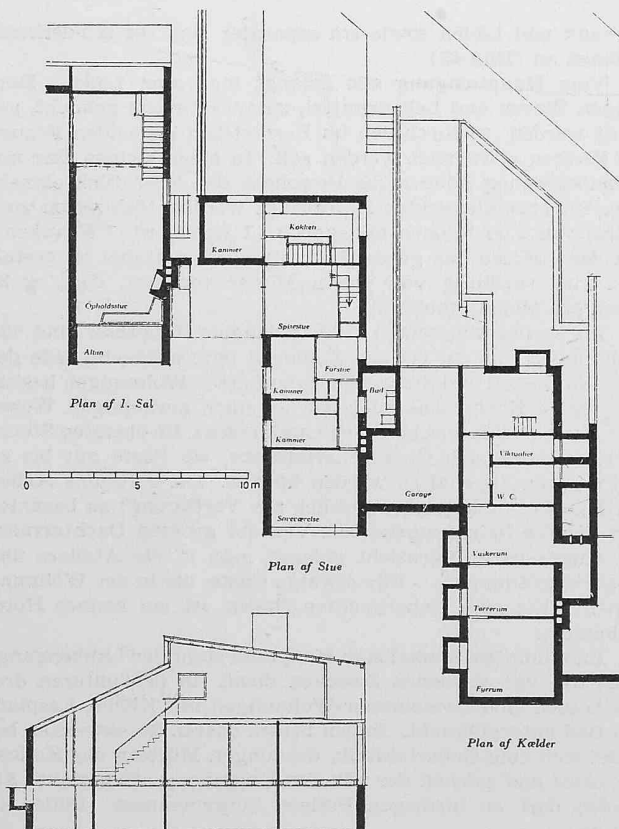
Reihenhaus in Soholm, Grundriss und Schnitt, 1:1000.
